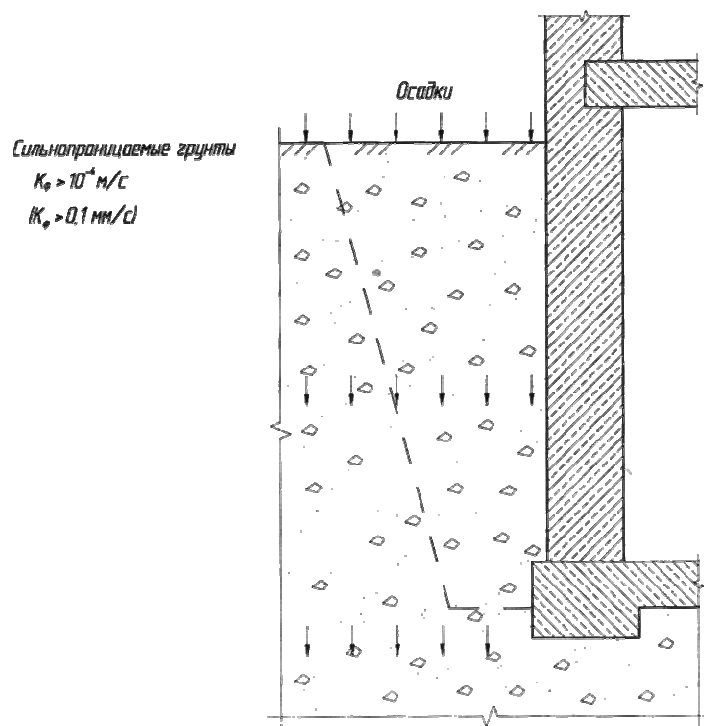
Расчётная схема нагрузки от воздействия грунтовой влаги
